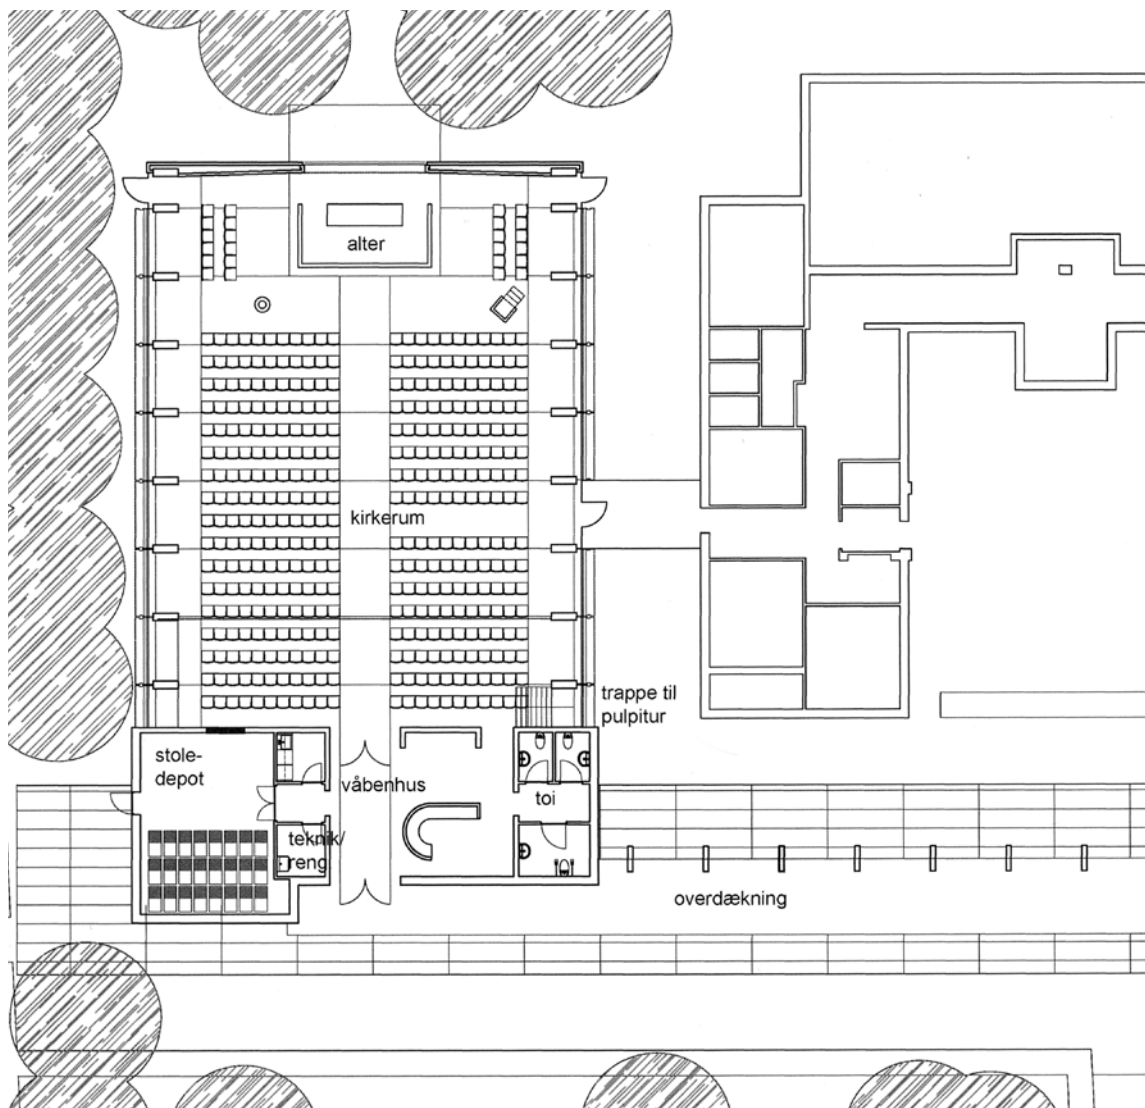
Grundplan. Projektforslag 2004. 1:300. – *Ground plan.
